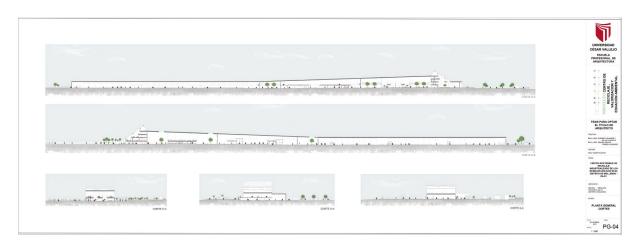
Plano General – Cortes FUENTE: Elaboración Propia
